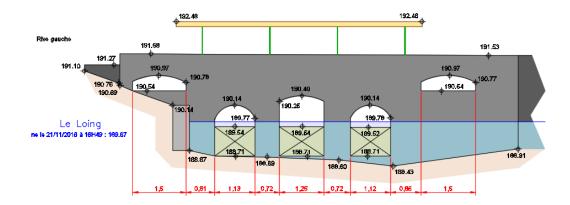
Coupe de l'ouvrage (passe de gauche)
